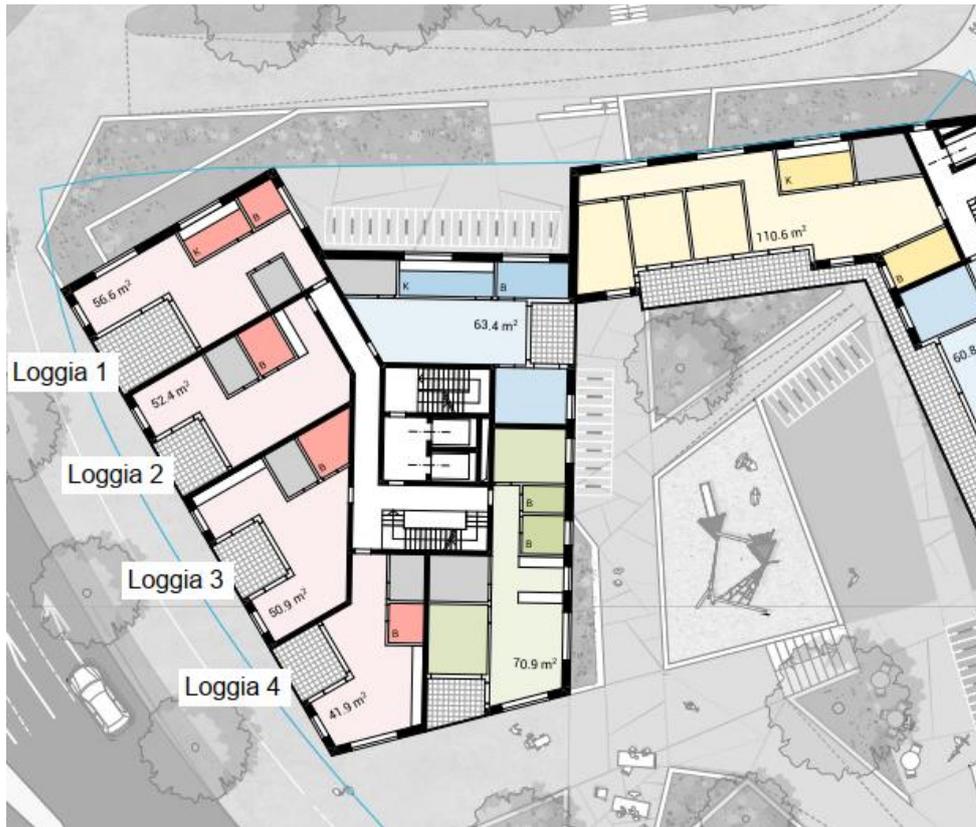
Richtprojekt mit lärmoptimiertem Grundriss im Nordwesten des 2. Obergeschosses Hochhaus Baubereich D
